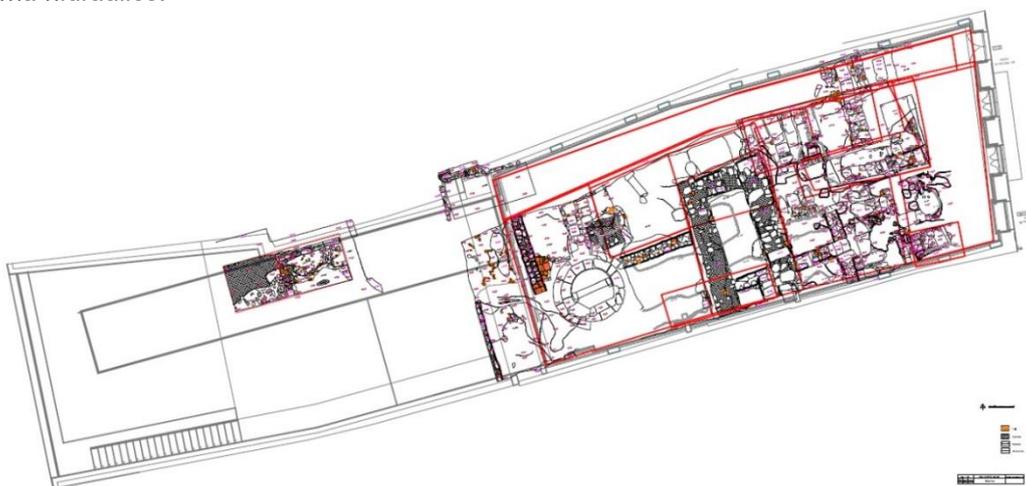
Planta geral da intervenção na Rua Frei Caetano Brandão n° 166/168
